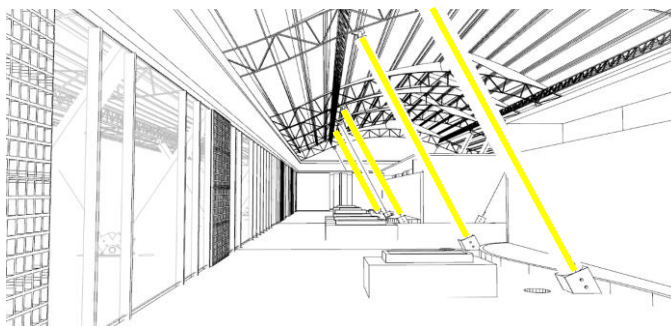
Estructuras de acero como columnas. Fuente: propia
